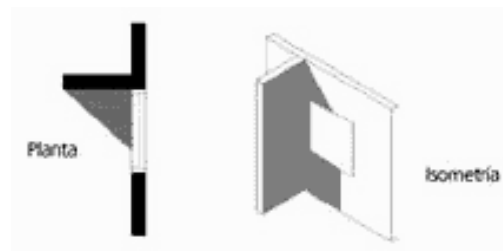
Detalle de un protector solar vertical para bloquear ángulos bajos del sol en fachadas sur, sureste y suroeste
